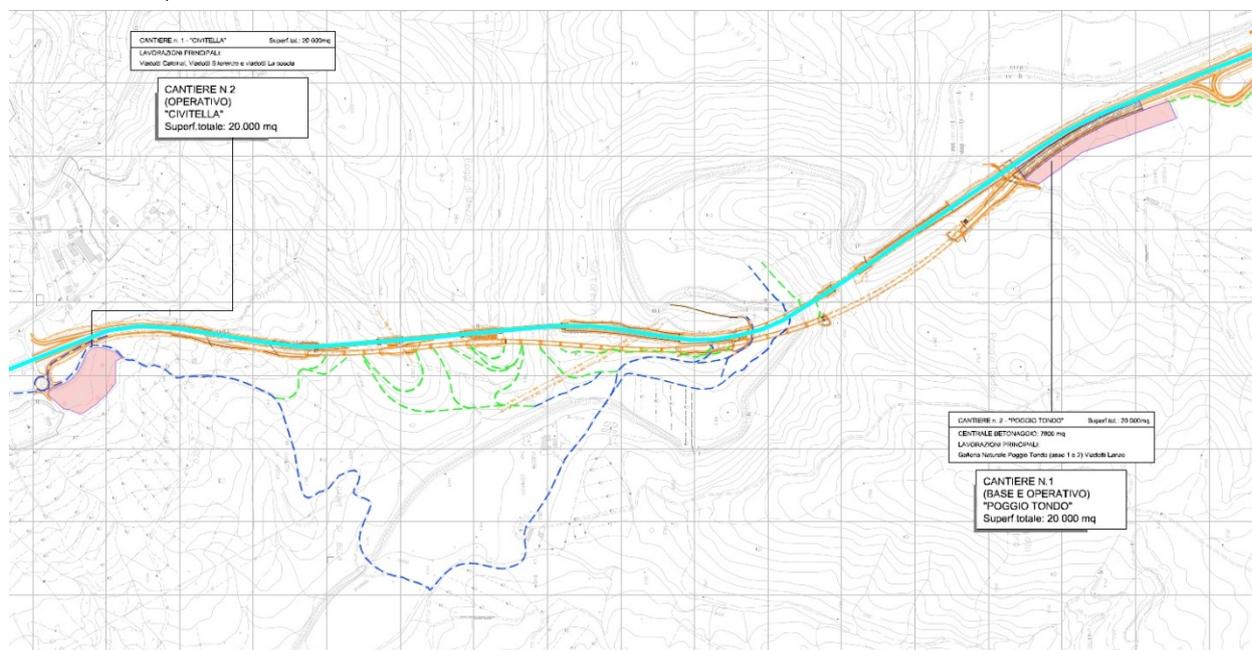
Planimetria con individuazione dei cantieri base e operativi.
